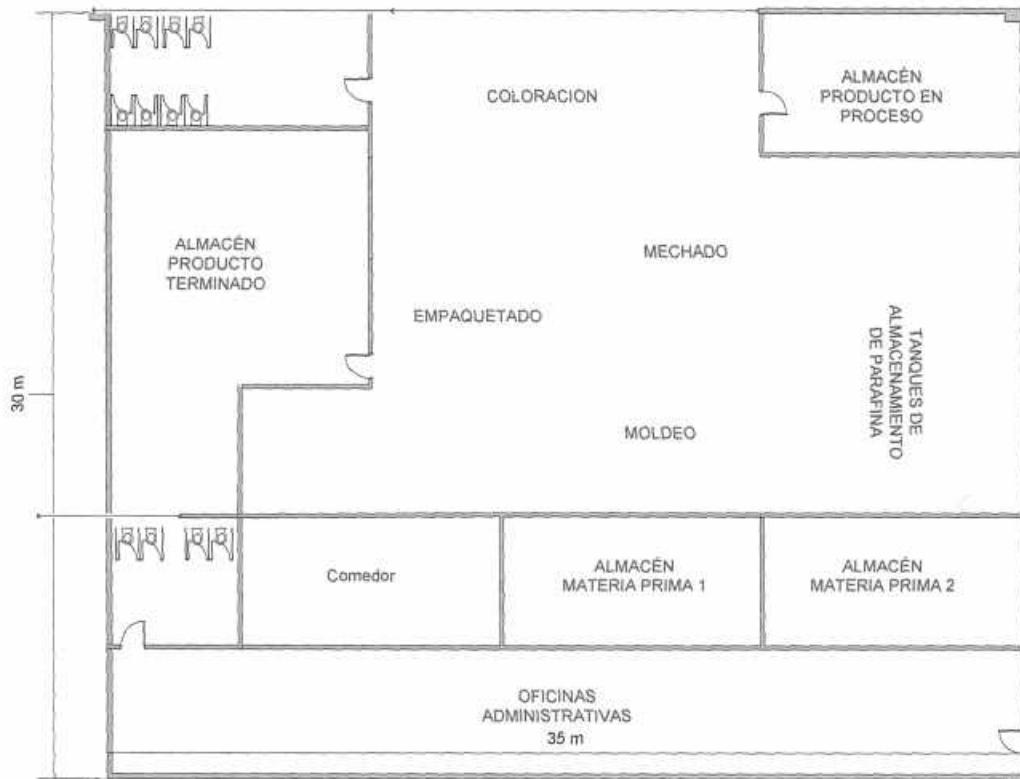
Layout Actual de la Planta. Fuente: Dueño.
